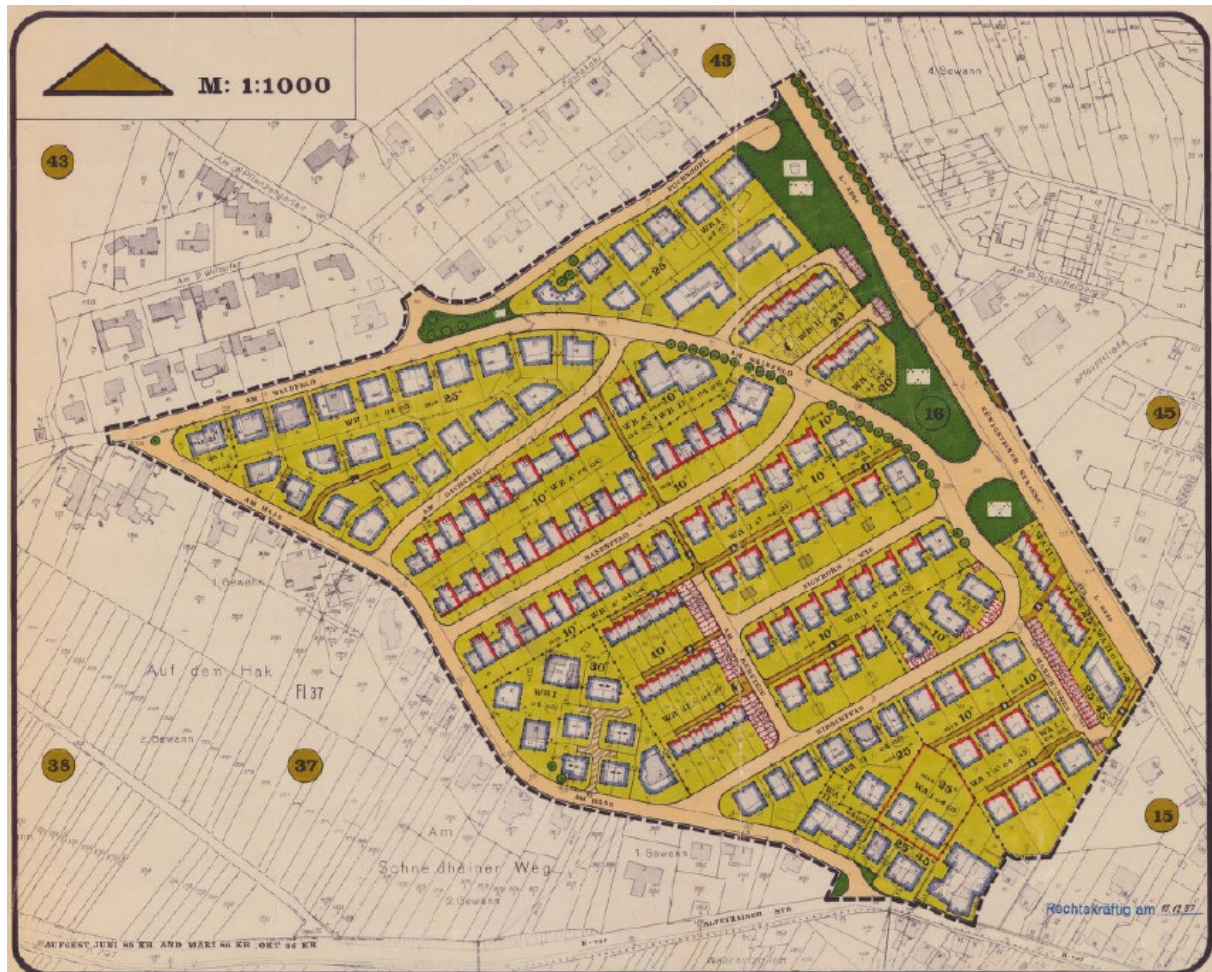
Bebauungsplan Nr. 3 „Unterhalb der Fuchshohl“
